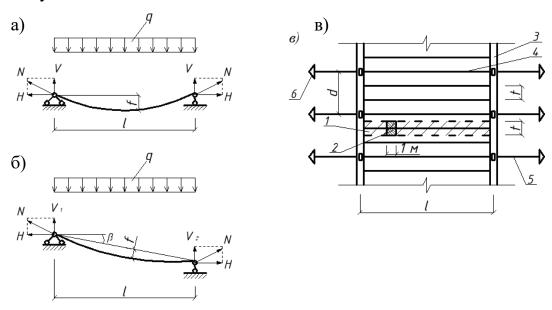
Расчетная схема параллельных вант в висячей оболочке: а – с опорами в одном уровне, б – с опорами в разных уровнях, в – фрагмент плана покрытия; 1 – грузовая полоса, 2 – грузовая площадка на 1 п. м ванты, 3 – бортовой элемент, 4 – ванта, 5 – оттяжка, 6 – анкер
